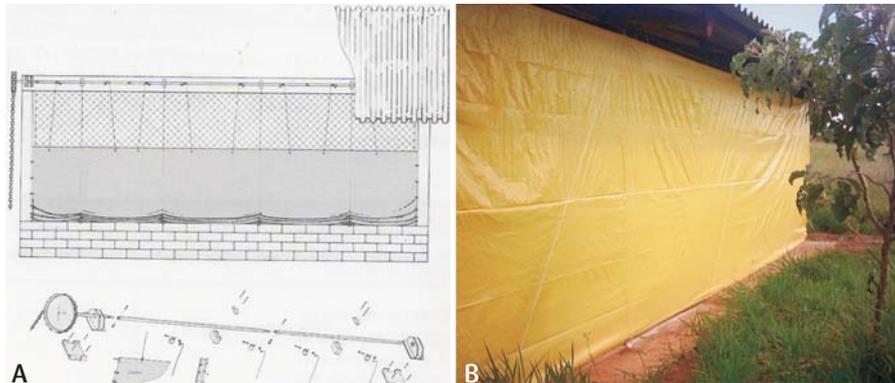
A: detalhes da montagem da cortina; B: cortina fixada adequadamente.
